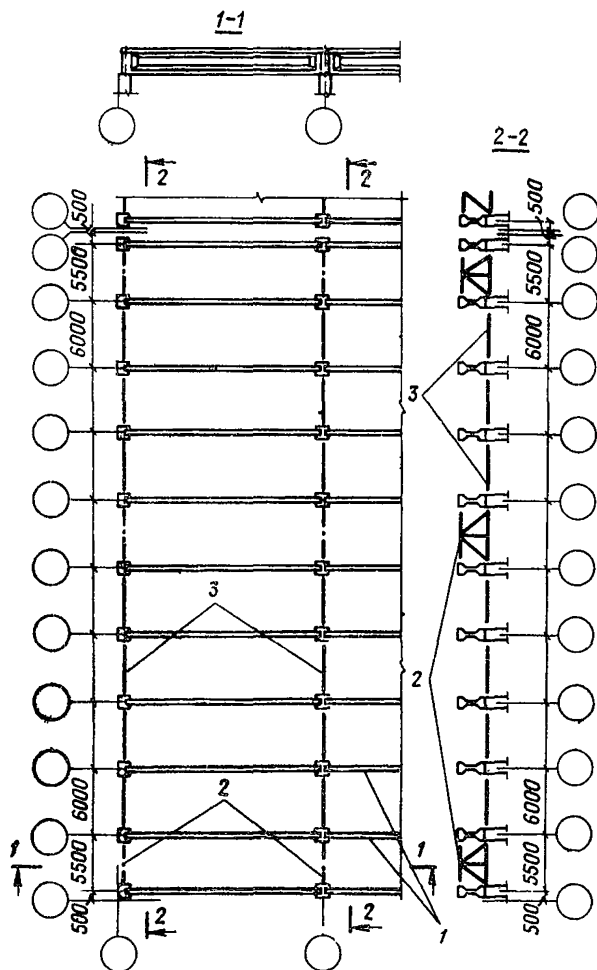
Пример расположения связей покрытия с балками (при плоской кровле) в зданиях с шагом колонн 6 м при расчетной сейсмичности 8 баллов
